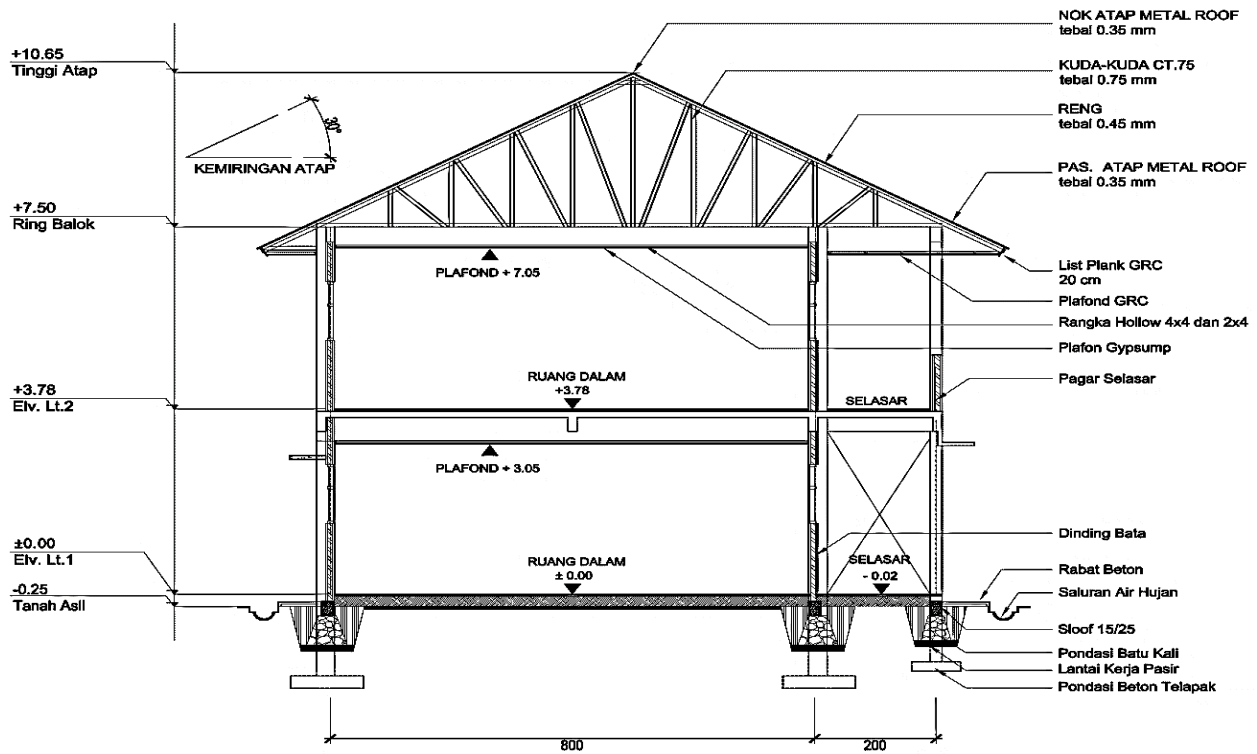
Contoh Tampak Pembangunan RKB di lantai 2
